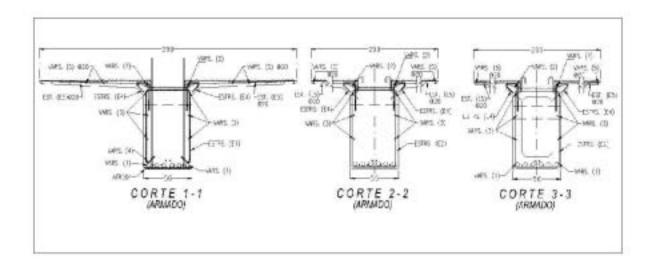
Corte y armado tipo en extremos de trabes o losas sección rectangular con aleros.
